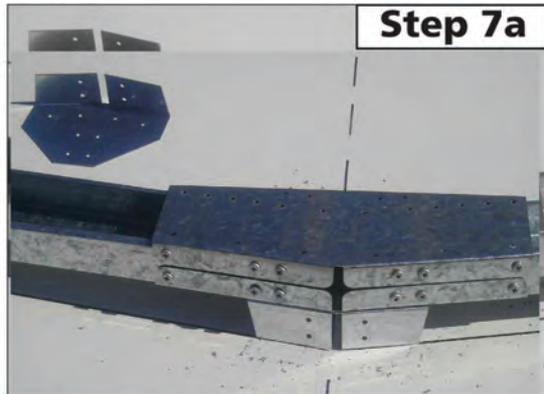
PHOTOS D'ASSEMBLAGE DU PORTIQUE CENTRAL
